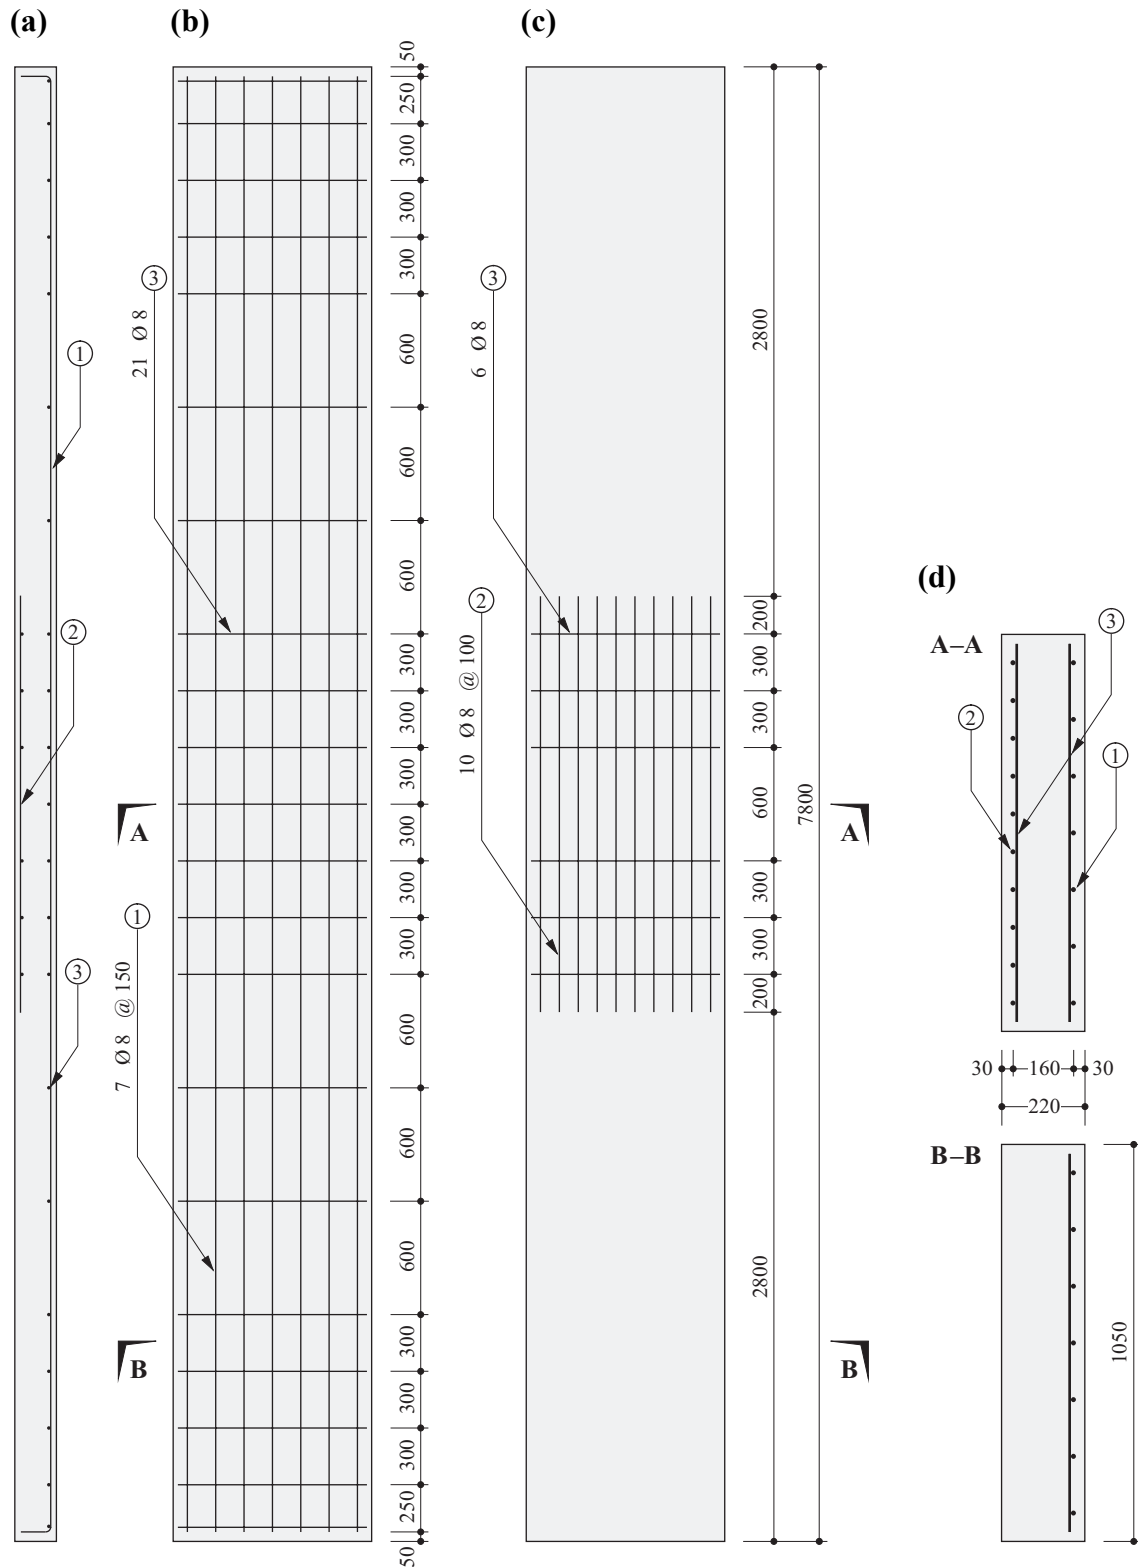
Abmessungen und Bewehrung der Plattenstreifen: (a) Längsschnitt; (b) untere Bewehrungslage; (c) obere Bewehrungslage; (d) Querschnitte; Abmessungen in mm.
